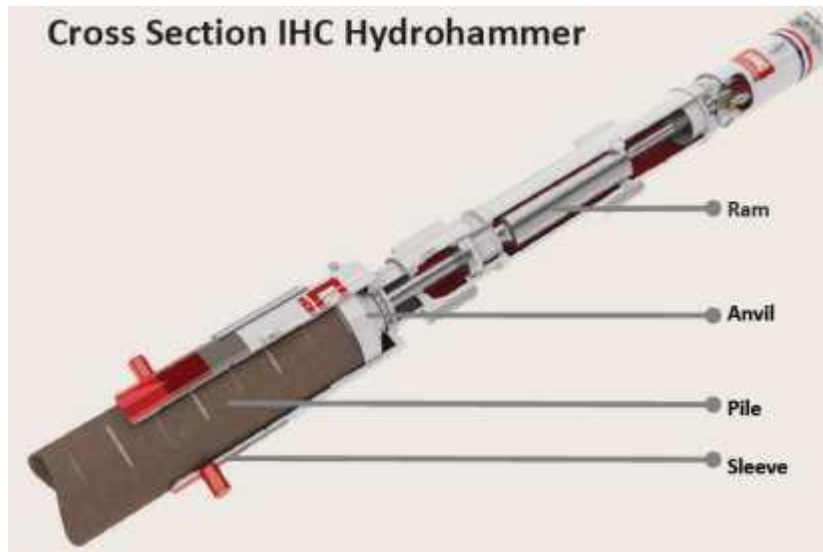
Sino / Adaptador para elevação e instalação da fundação.
